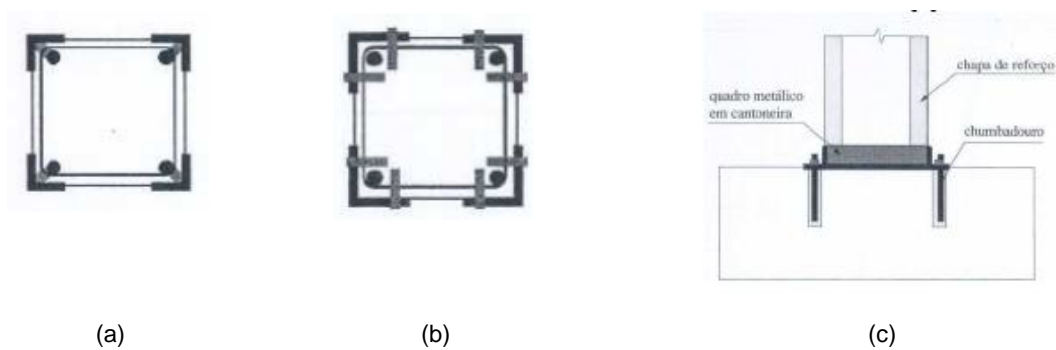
Reforço realizado com cantoneiras dispostas nos cantos, coladas ao betão com uma resina epóxi injetada e fixas à armadura principal por soldadura (a), por colagem de buchas (b) e a ligação à fundação é feita através de esquadros metálicos soldados aos perfis, fixos à fundação (c) – adaptado de Sousa (2008)
